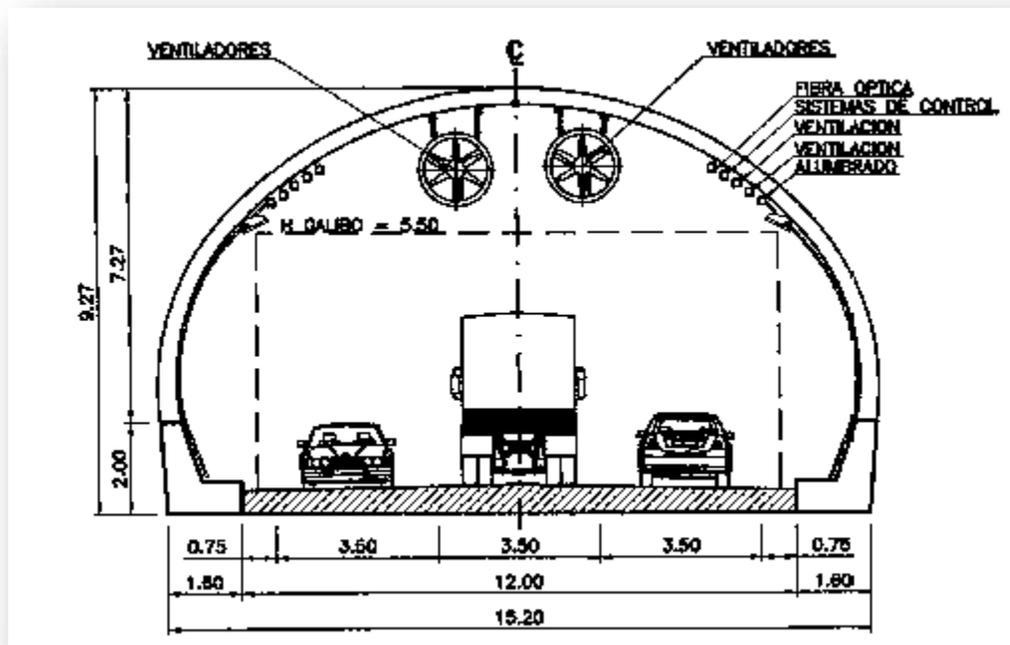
Ventiladores Sección tipo.. Fuente (Proyecto Ejecutivo).
